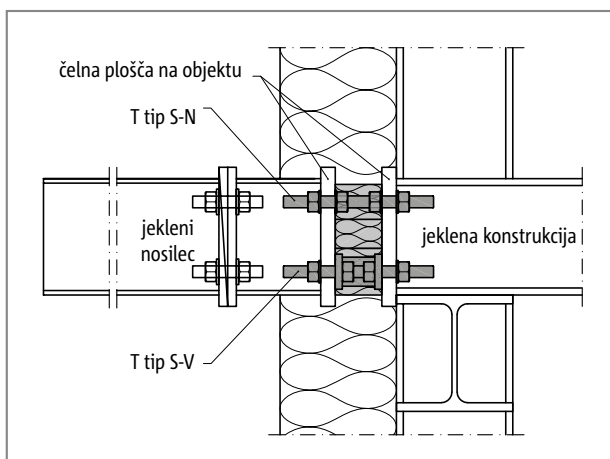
Schöck Isokorb® T tip S-V: podprta jeklena konstrukcija
